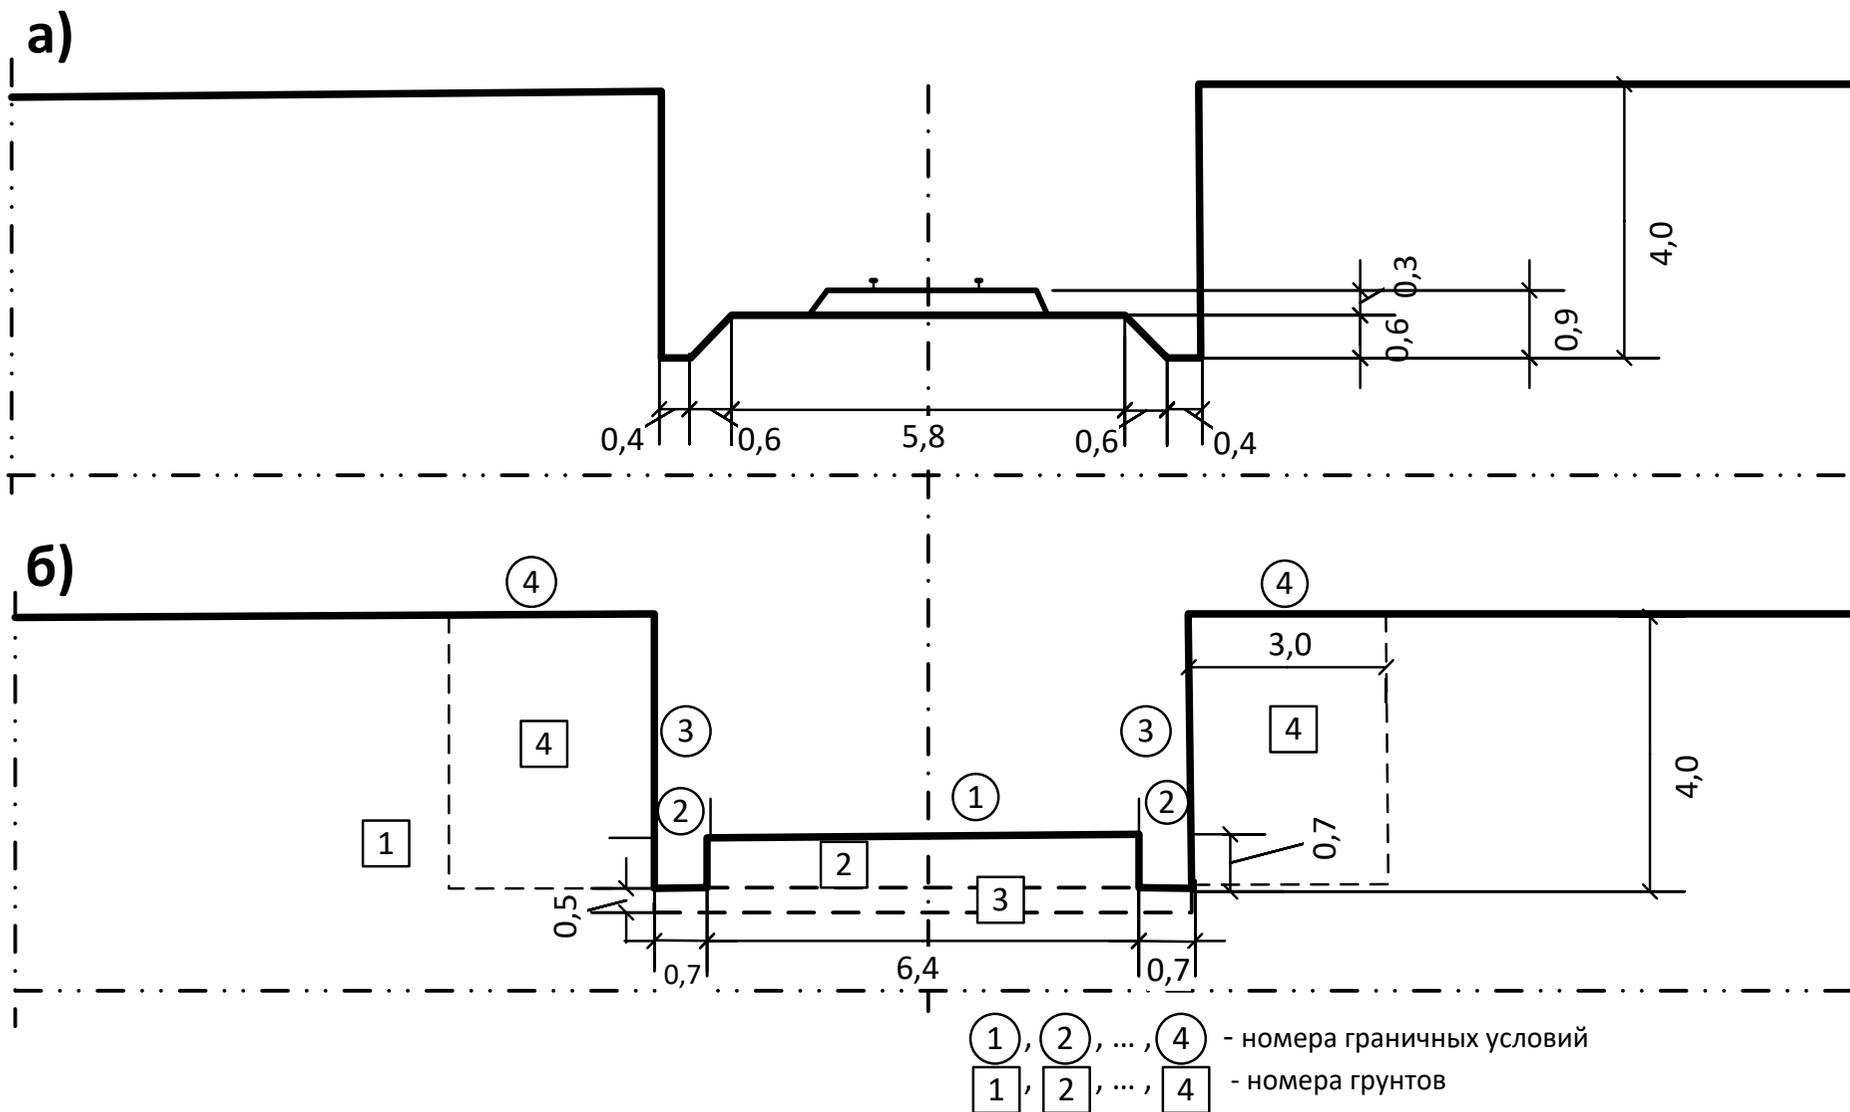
Поперечное сечение (а) и расчётная схема (б) выемки региона V (схема 5-2)
